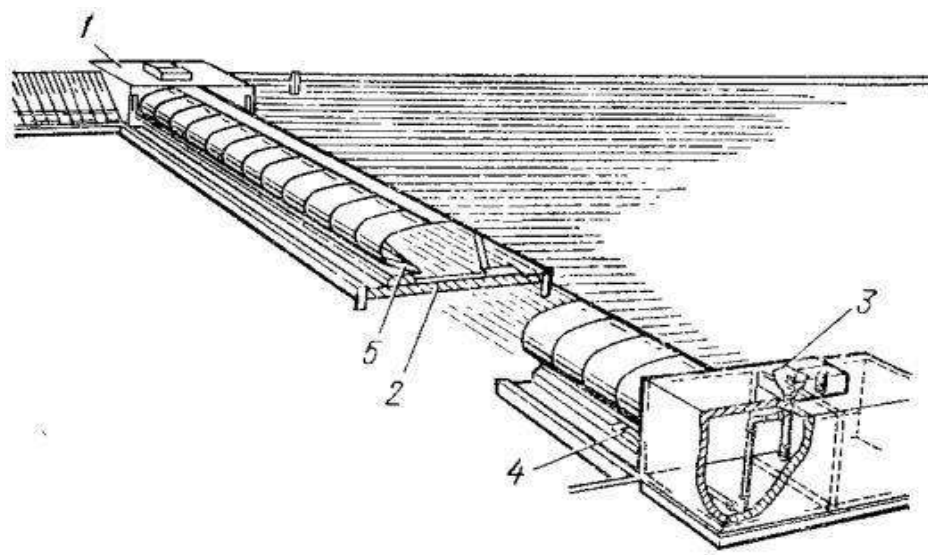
Пример защитной плотины на канале Веспертскваарт (Голландия): 1 – береговой устой, 2- бетонный флютбет, 3 –насосная станция, 4- трубопровод, 5 – металлические створки
